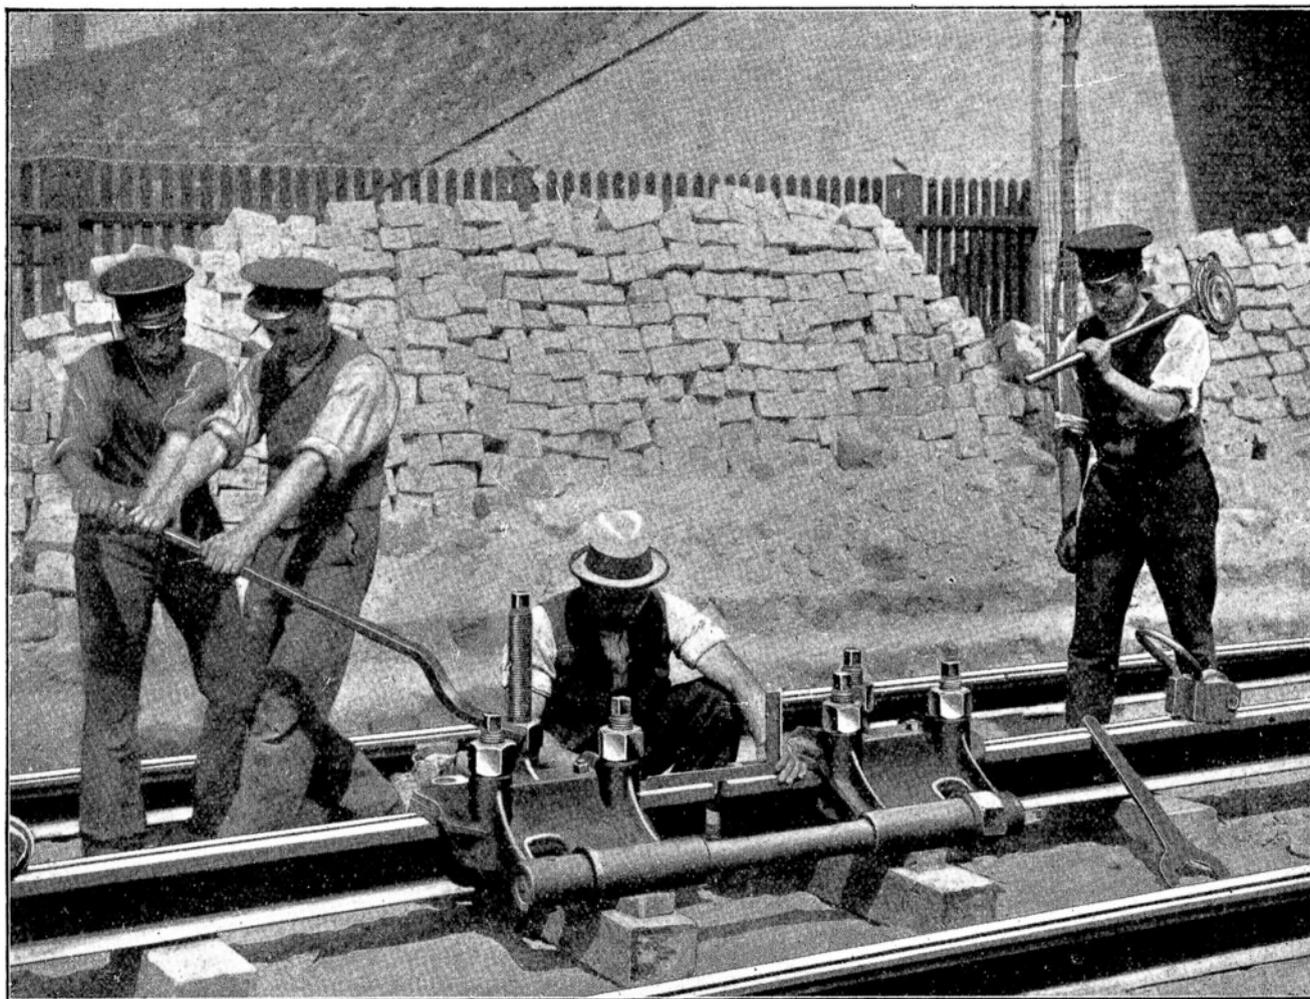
Klemmapparat für Thermit-schweißung.
